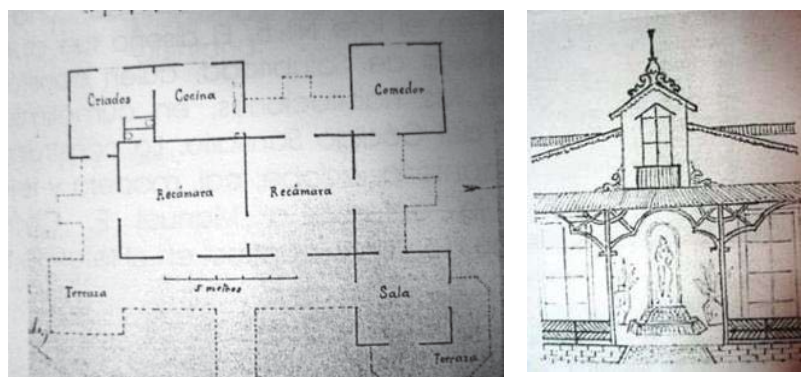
Lote Núm. 4, fachada y planta arquitectónica
